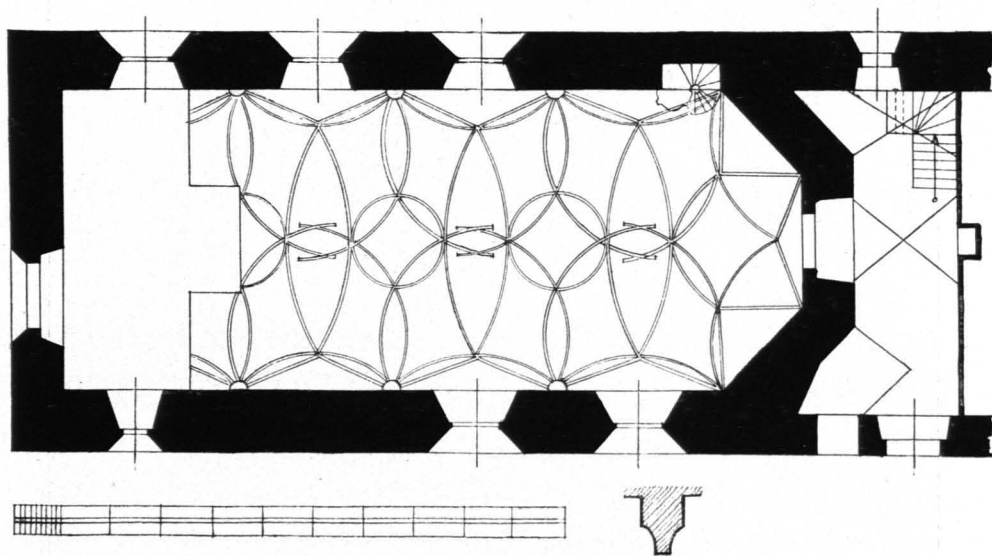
Hohensalzburg, Grundriß der Georgskirche, 1 : 150 (S. 97)
